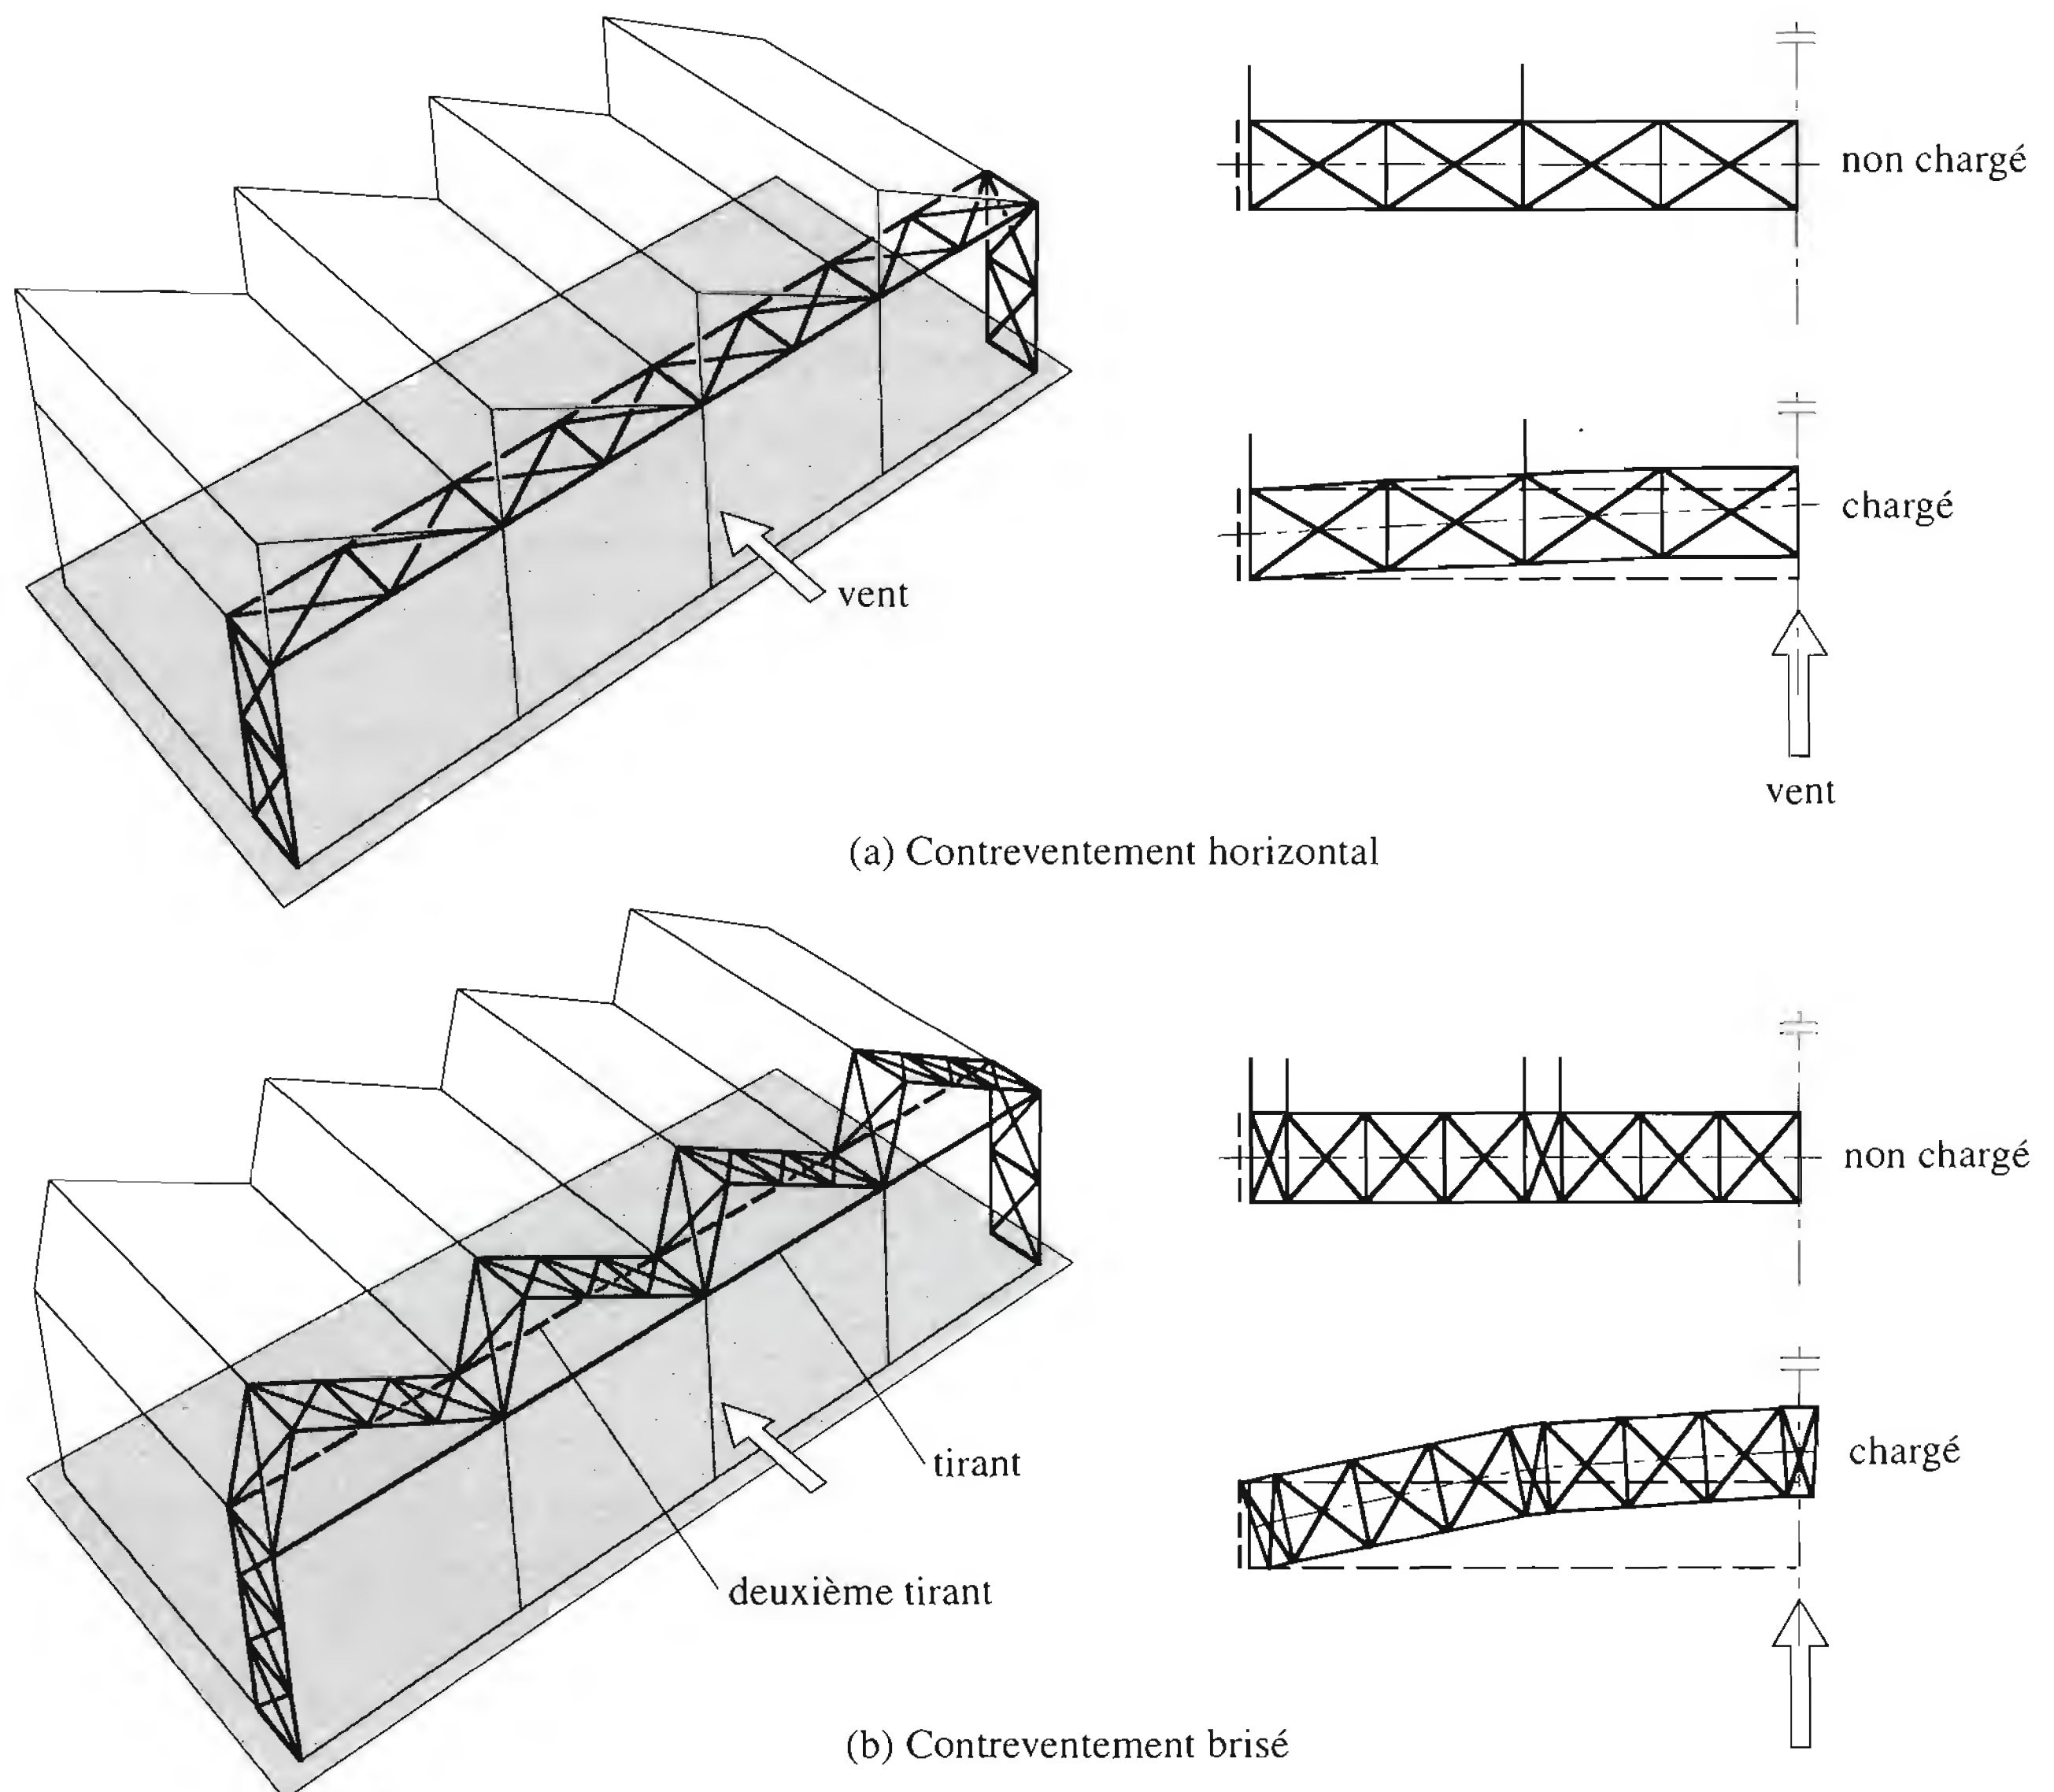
Stabilisation transversale d'une halle en shed.
